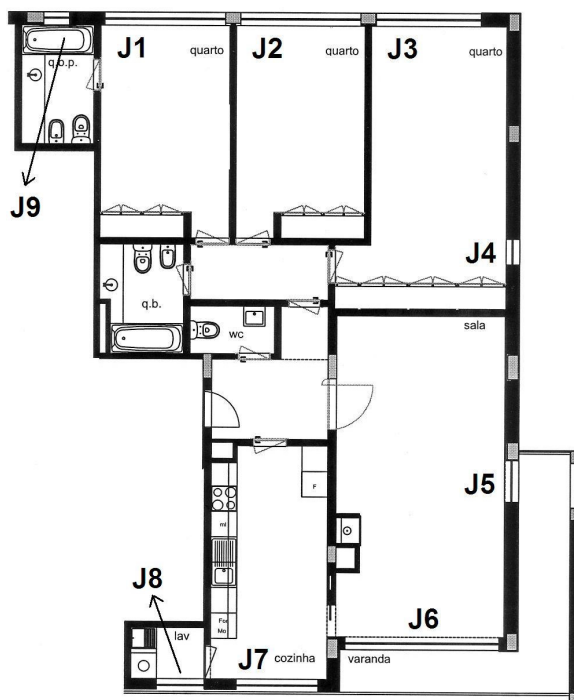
Planta do fogo em análise e indicação das janelas exteriores
